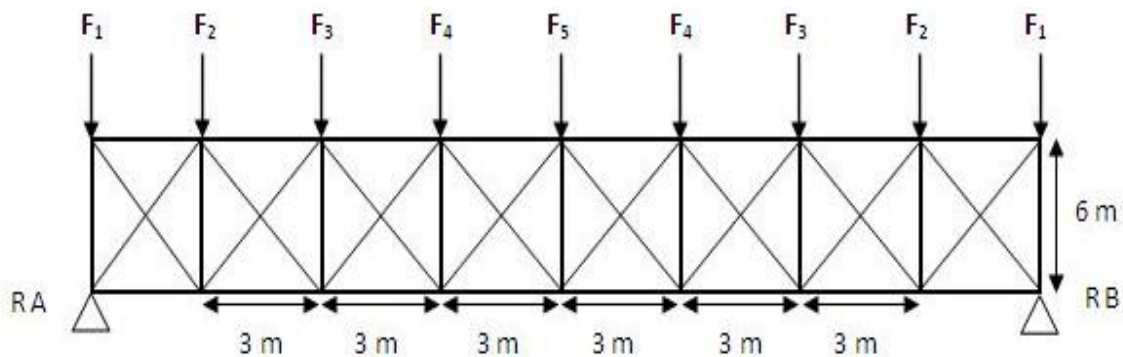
schéma statique de la poutre au vent sur le pignon.
